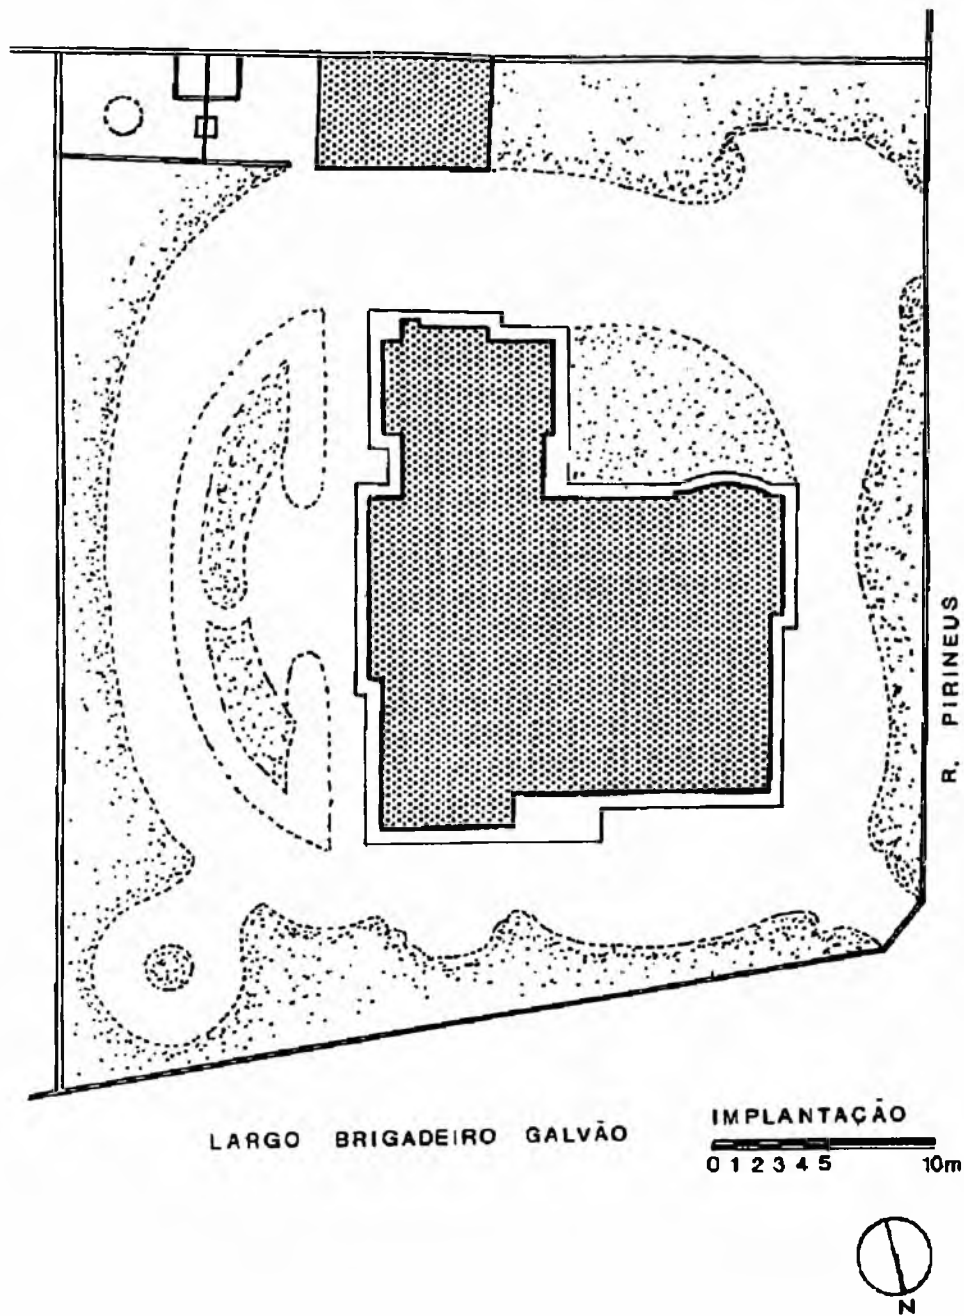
Implantação do palacete que pertenceu ao fazendeiro de café Antônio Lacerda Franco. Situado na esquina da rua dos Pirineus com o largo Brigadeiro Galvão, data de 1906, conforme planta e construção de autoria do arquiteto franco-brasileiro Victor Dubugras, um dos profissionais mais expressivos que construíram em *Art Nouveau* em São Paulo, no começo do século.
